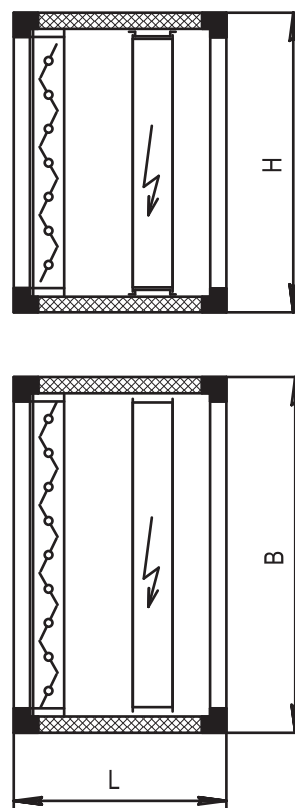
Габаритные размеры моноблока состоящего из клапана и воздушонагревателя электрического
